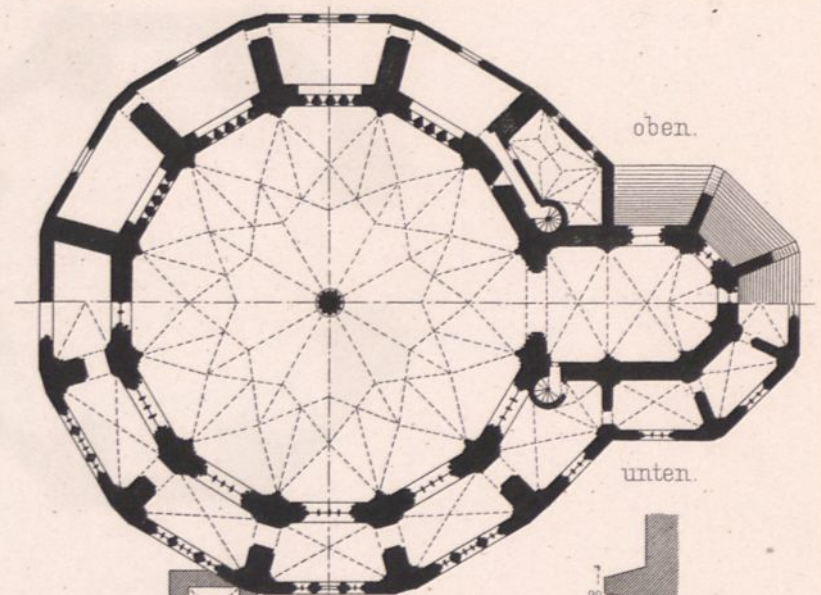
Zweiter Bauabschnitt. Grundriss.
